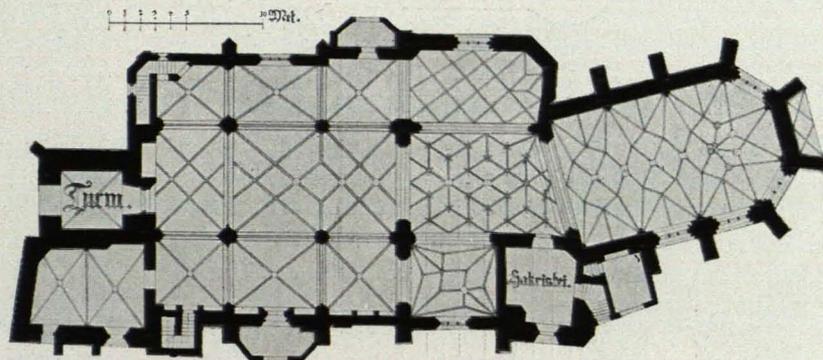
Spitz, Pfarrkirche, Grundriß 1:500 (S. 383)
